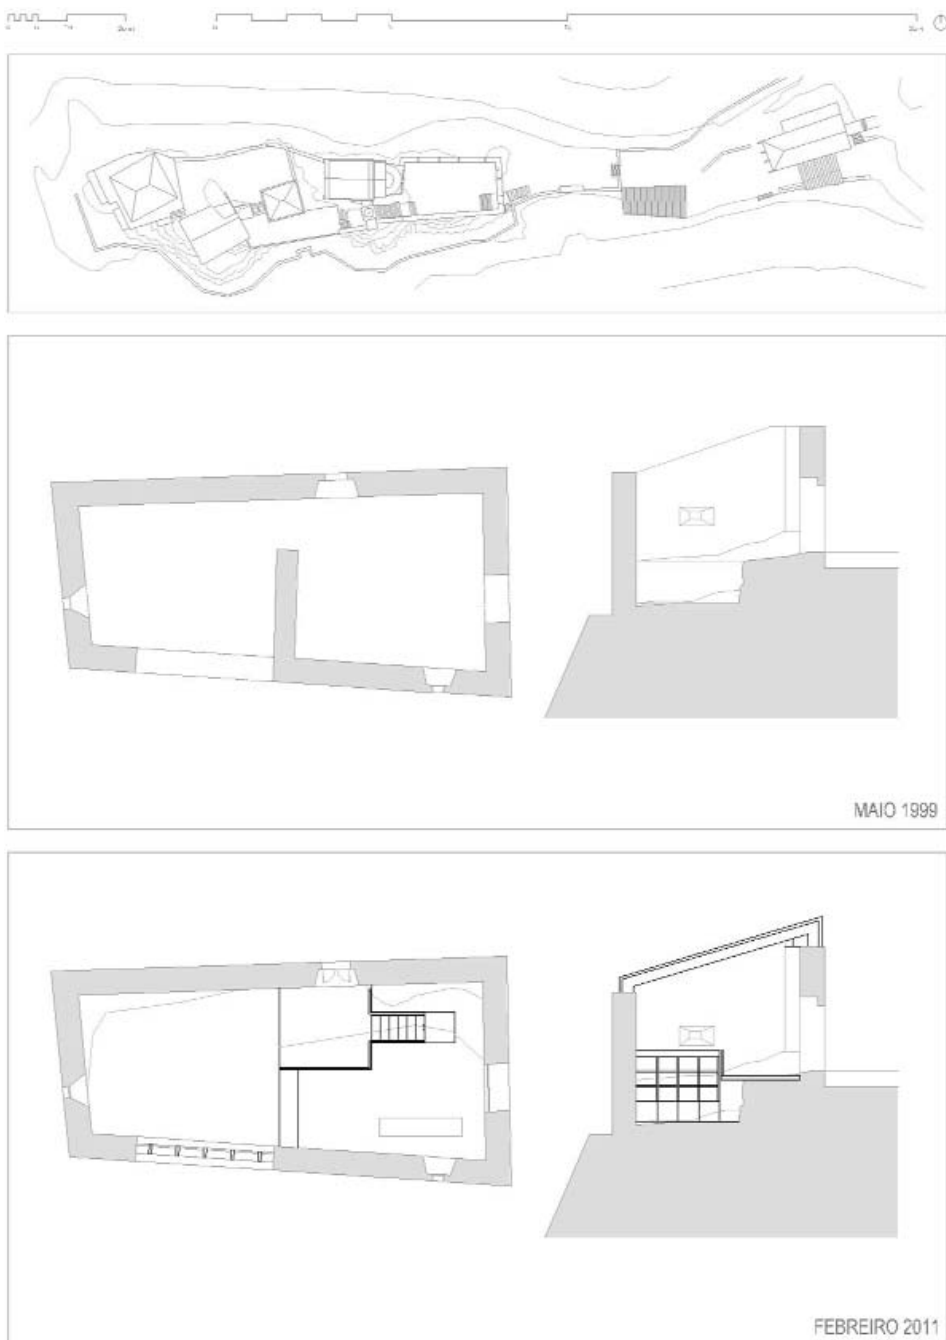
CAAVEIRO. Planta e sección transversal do Pavillón de información.
